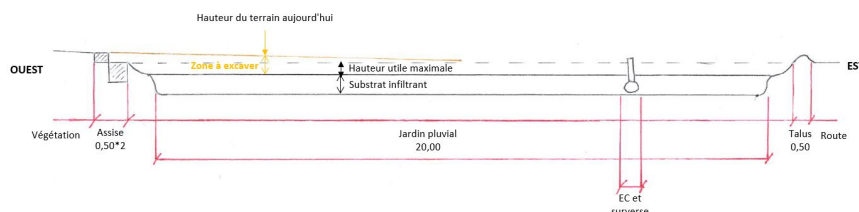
Plan du profil du jardin pluvial de la zone SUD, au niveau de la coupe 2.
